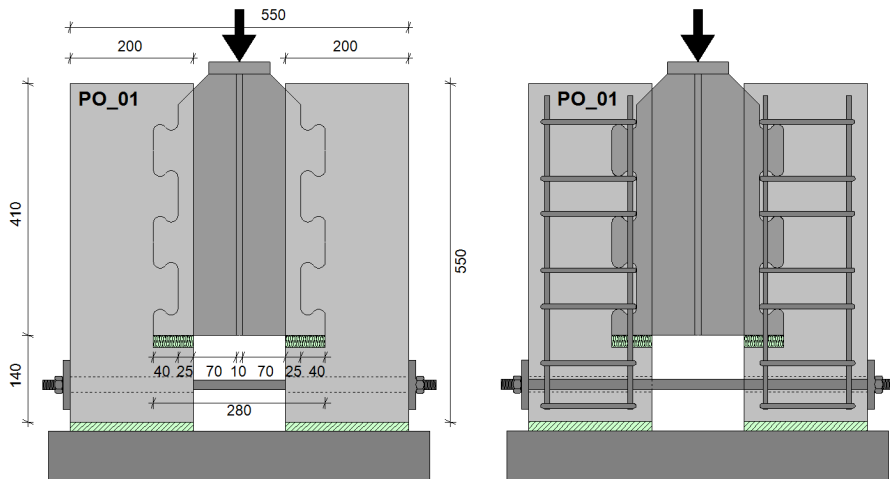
Push-Out-Versuchsaufbau mit Abmessungen (links) und Bewehrungsanordnung (rechts)
